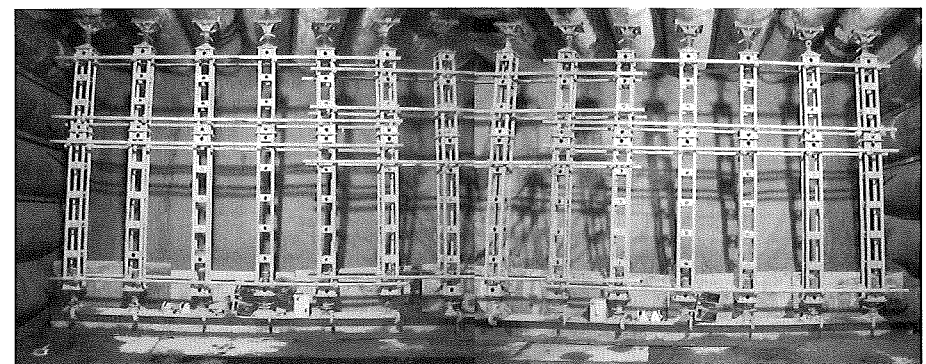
吹付けコンクリートおよび仮設支柱断面図(合成写真)
